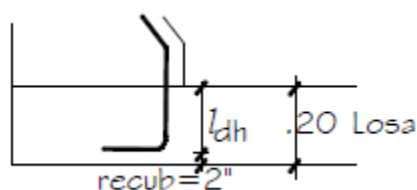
Longitud de desarrollo del refuerzo de la barrera sobre la losa de volado.
